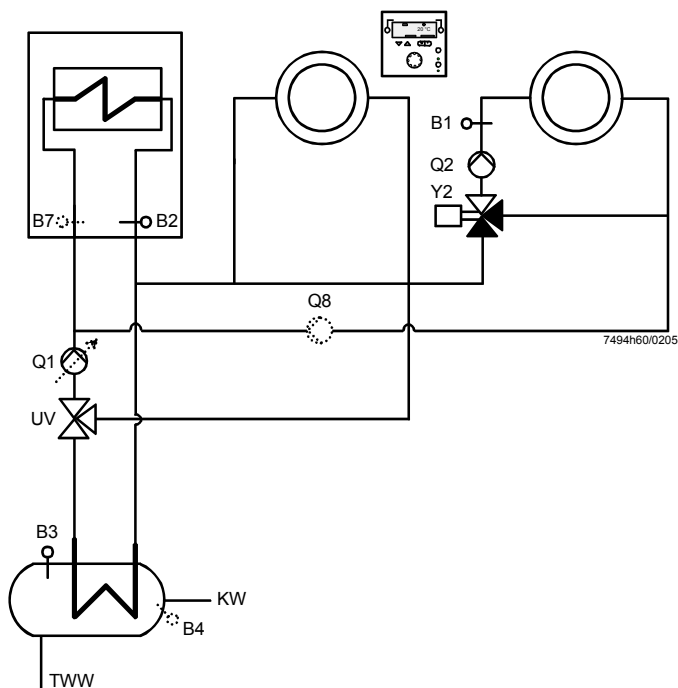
Systém zásobníku s čerpadlovým topným okruhem a směšovacím topným okruhem
